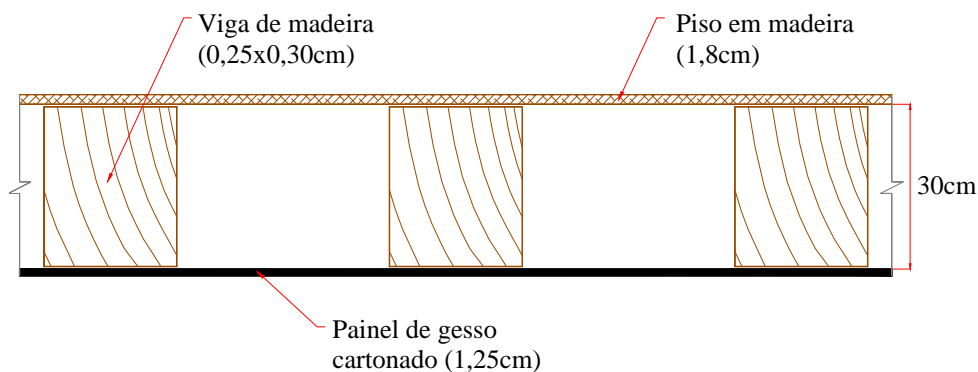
Pavimento de estrutura descontínua em madeira sem isolante (Pav13)
